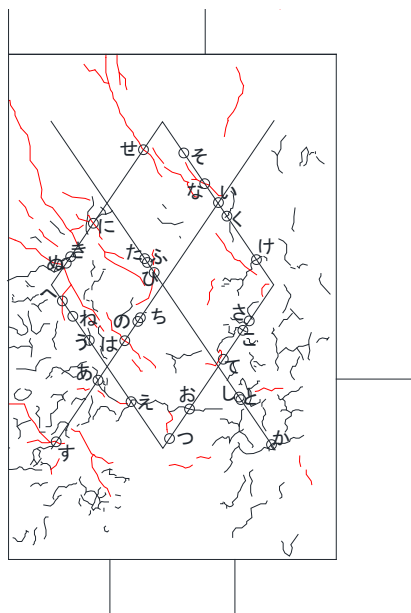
パイルキャップひび割れ幅測定位置(試験体 C-3 負荷荷)
